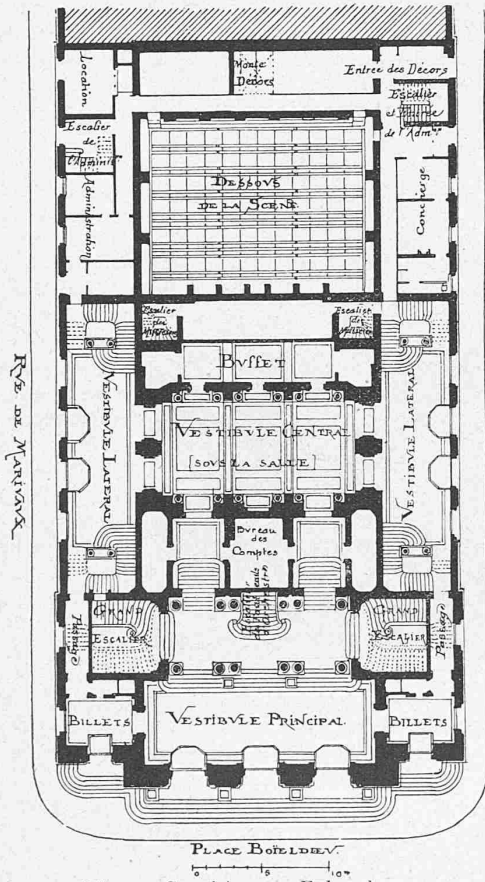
Grundriss vom Erdgeschoss.
